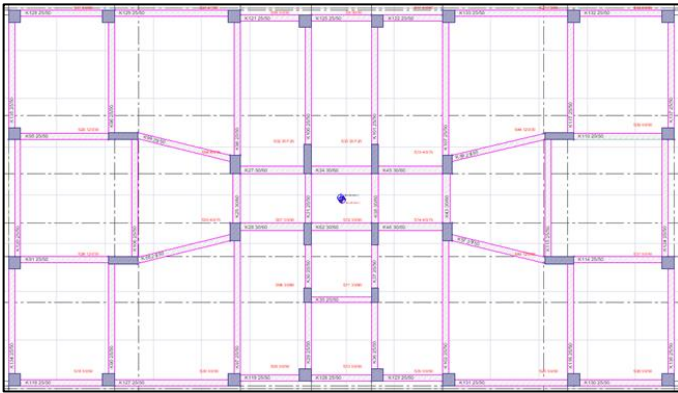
Yapıdaki tüm betonarme perdelerin kaldırılarak bodrum perdesi kullanımı ile oluşturulan P4 planı
